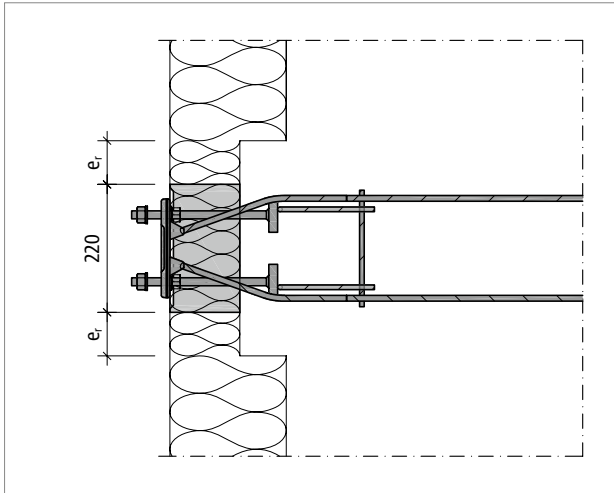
Schöck Isokorb® XT type SQ : distances aux bords
